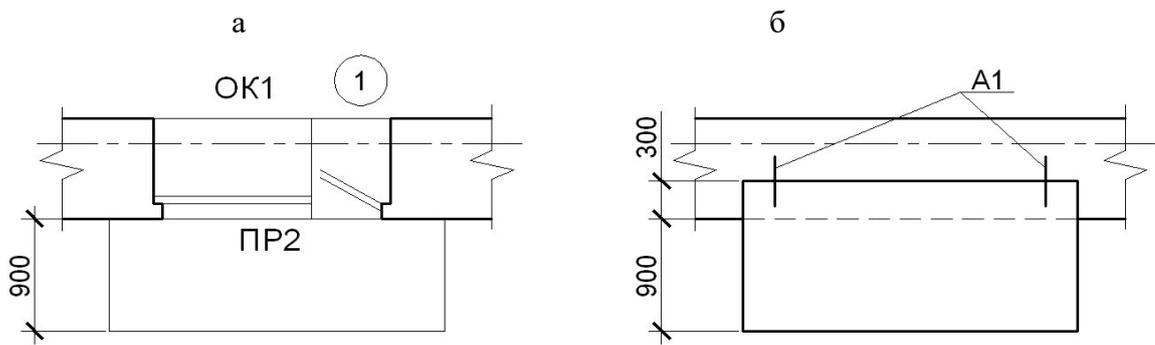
Планы балконов: а – на плане этажа, б – на плане перекрытий.
